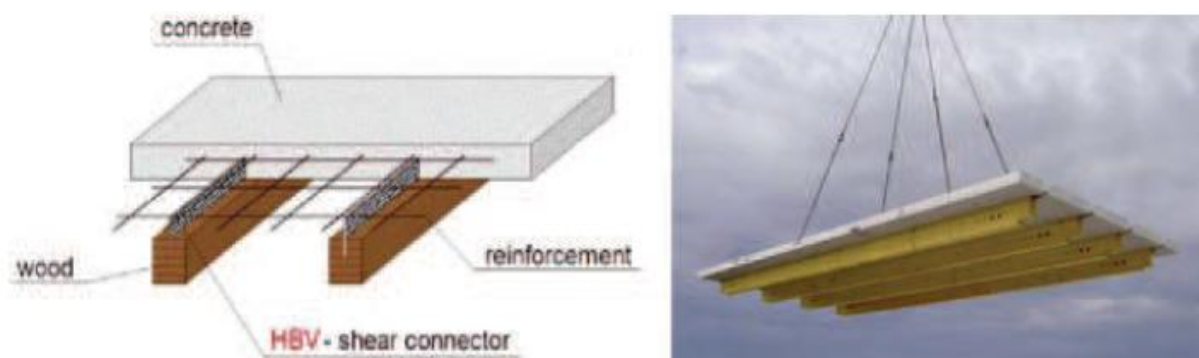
Exemple d'un plancher préfabriqué en bois-béton utilisé en ALLEMAGNE
